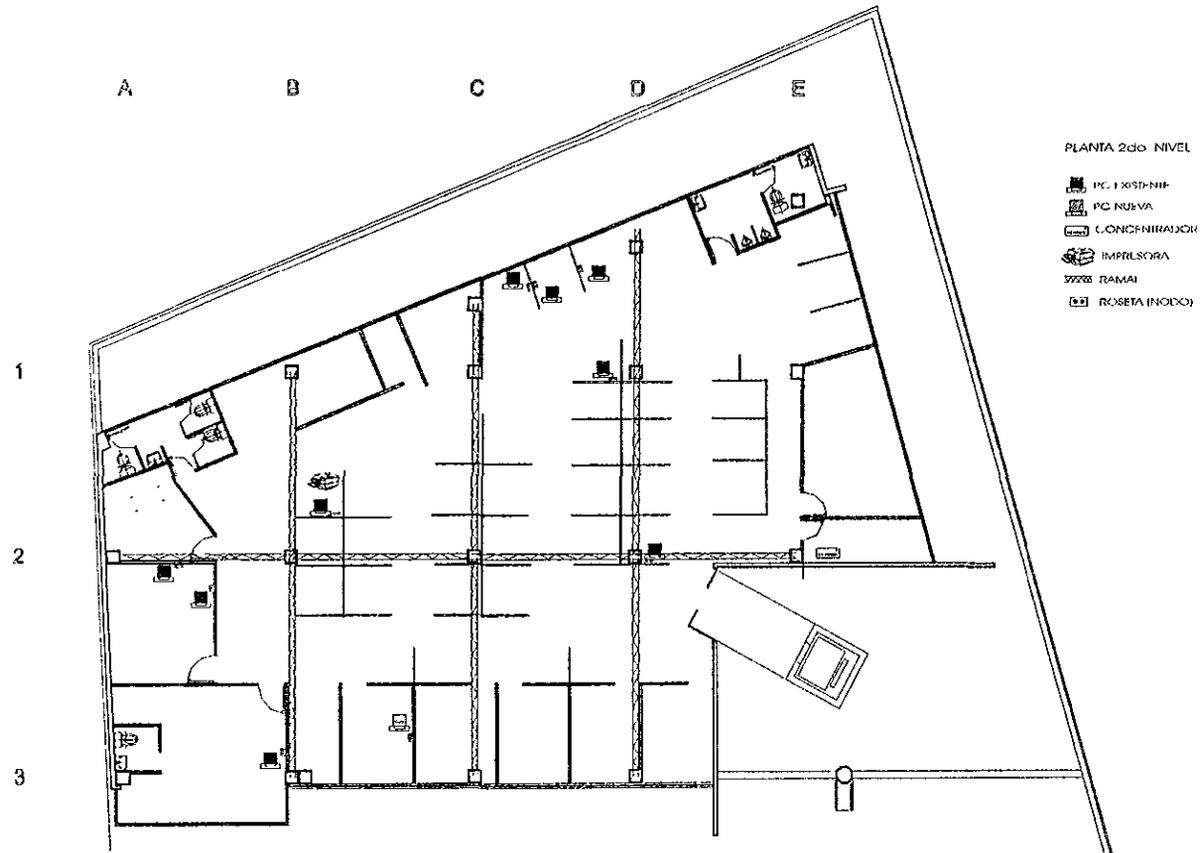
Distribución en la segunda planta de la DEPE.
